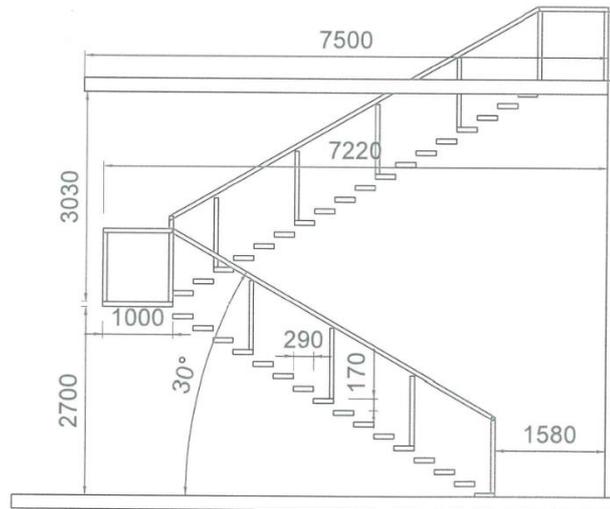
Geplante Außentreppe an der Westseite des Wohngebäudes auf der Gp. 6534 laut Planunterlagen der Sallinger Metallbau GmbH (ohne Maßstab)
